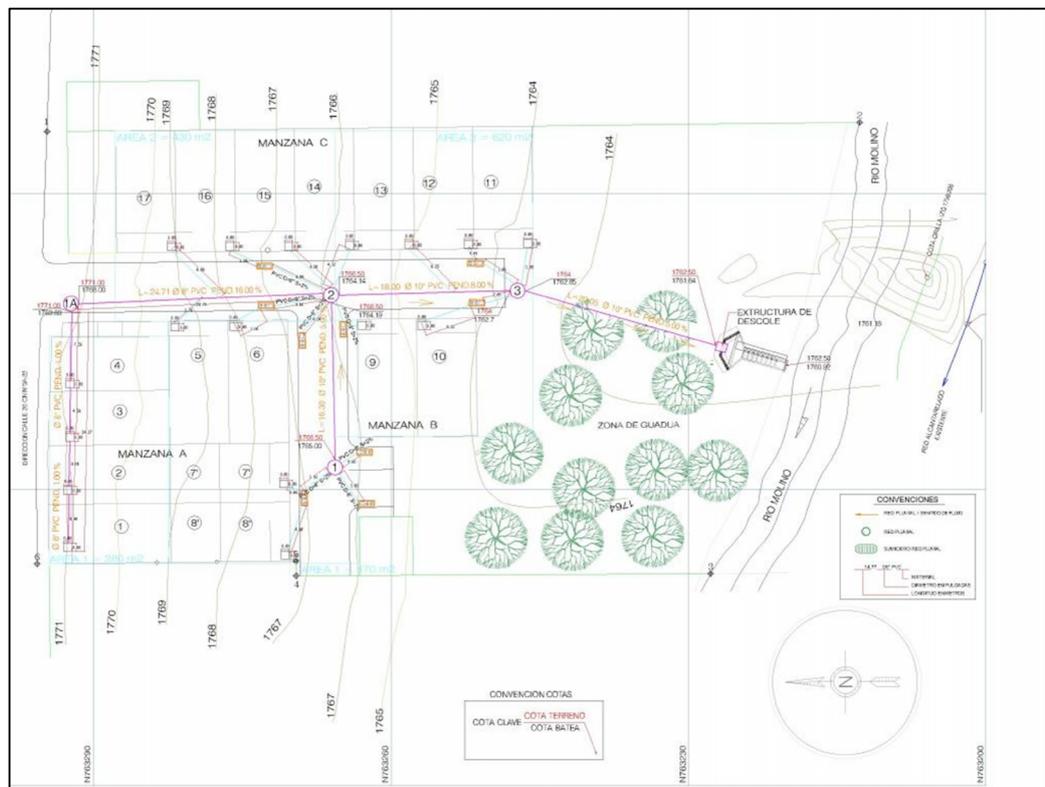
Plano “RED ALCANTARILLADO PLUVIAL”, Ing. Víctor Rivera
